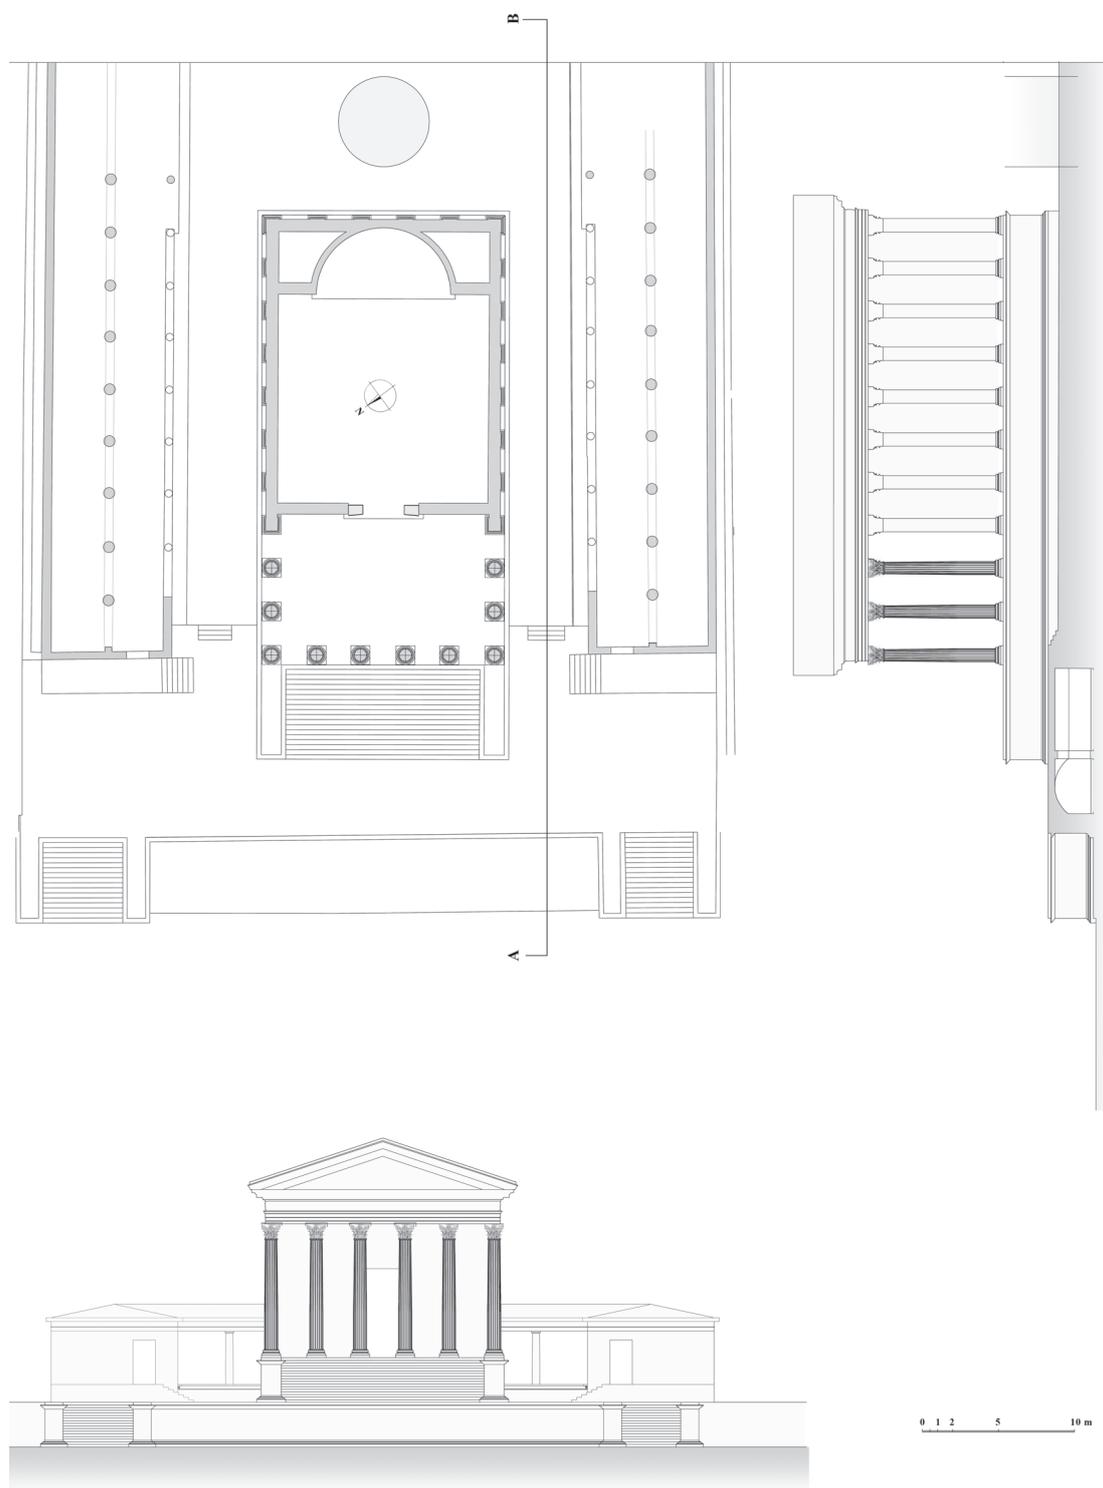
Ricostruzione schematica del Tempio: pianta, prospetto Ovest e sezione parzialmente integrata A-B con prospetto Sud. Scala 1:500.
